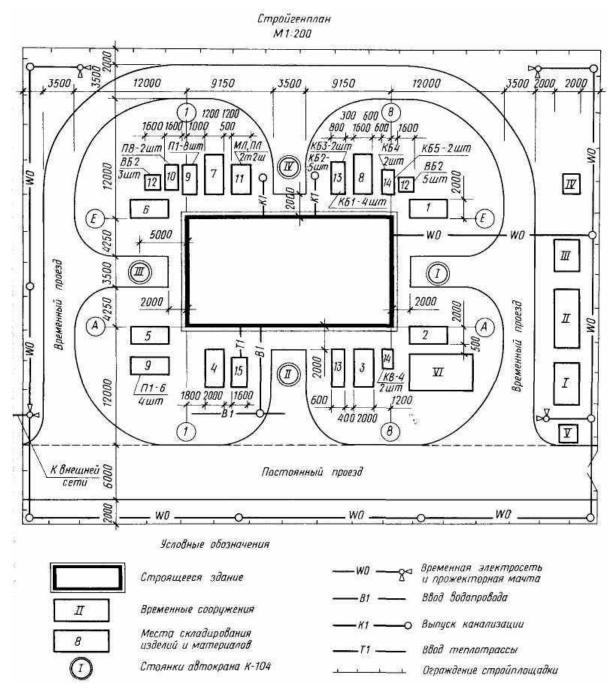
Пример выполнения строительного генерального плана .. Таблица 7.2
